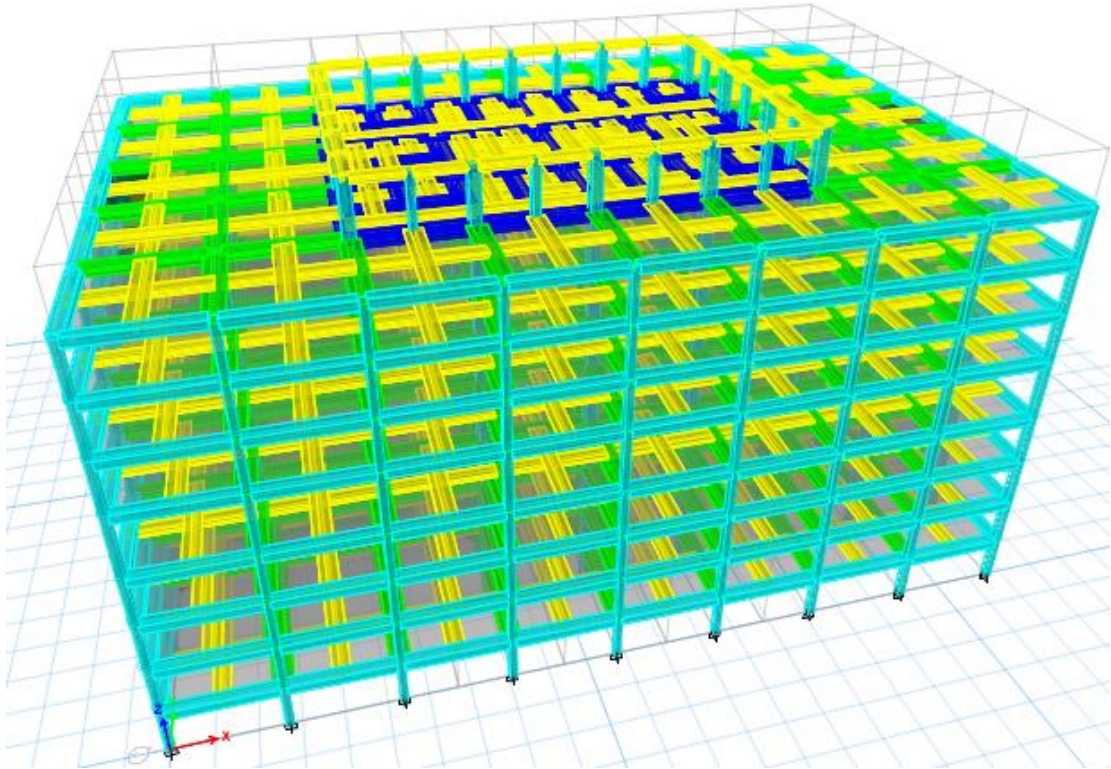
Denah Model 3 Lantai 8 dengan *Seaworld* di Lantai 8
